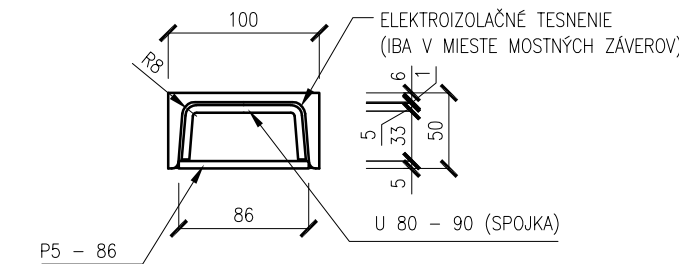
DETAIL ÚCHYTU ZÁBRADLIA M 1:5
